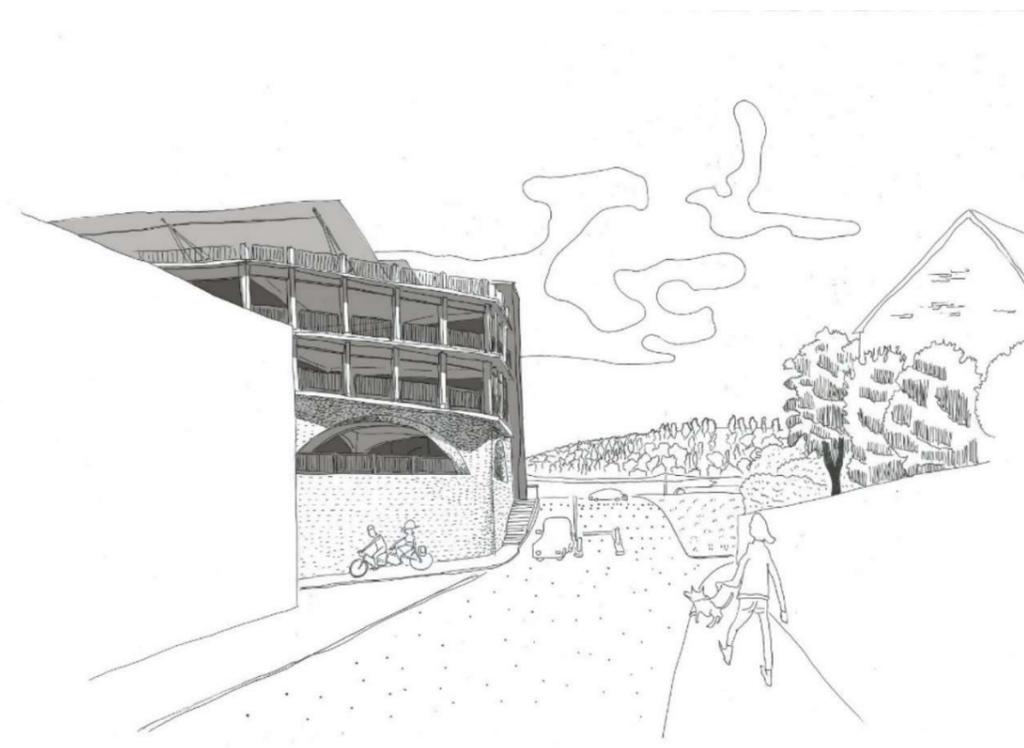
Croquis du projet de parking silo (source : SNCF Gare & connexions, avril 2022)
